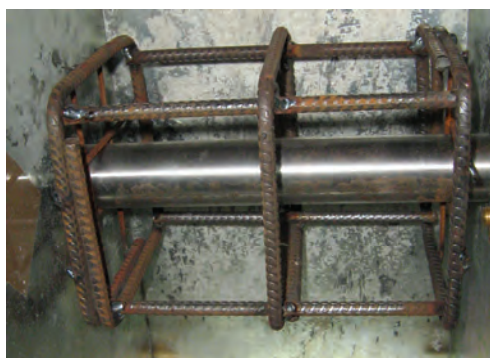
cage d'armature pour renforcement des zones d'appui des poutres non armées mise en place dans le coffrage avant coulage
